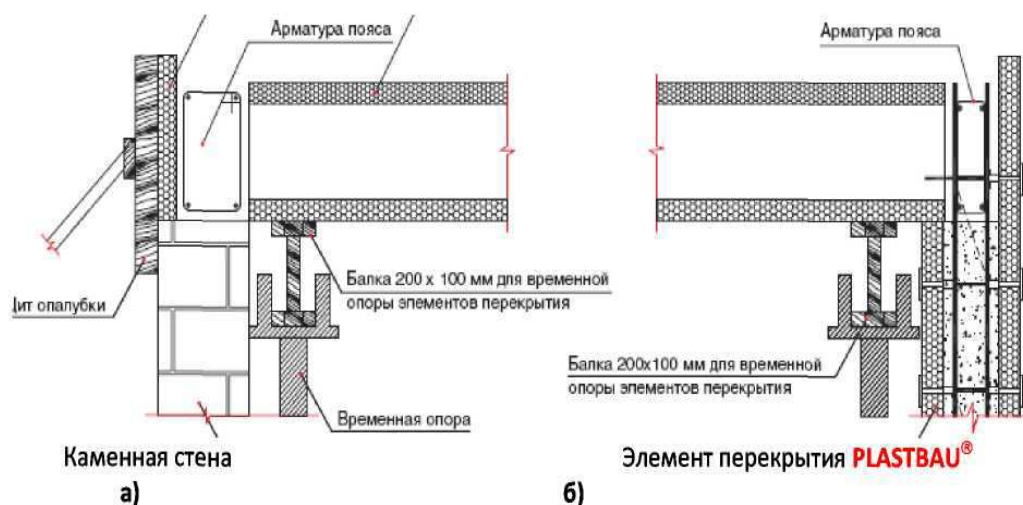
Выполнение опоры торцов элементов опалубки перекрытия: а- на кирпичной стене; б- на внутренней ППС плите элементов стеновой опалубки системы PLASTBAU-3.
